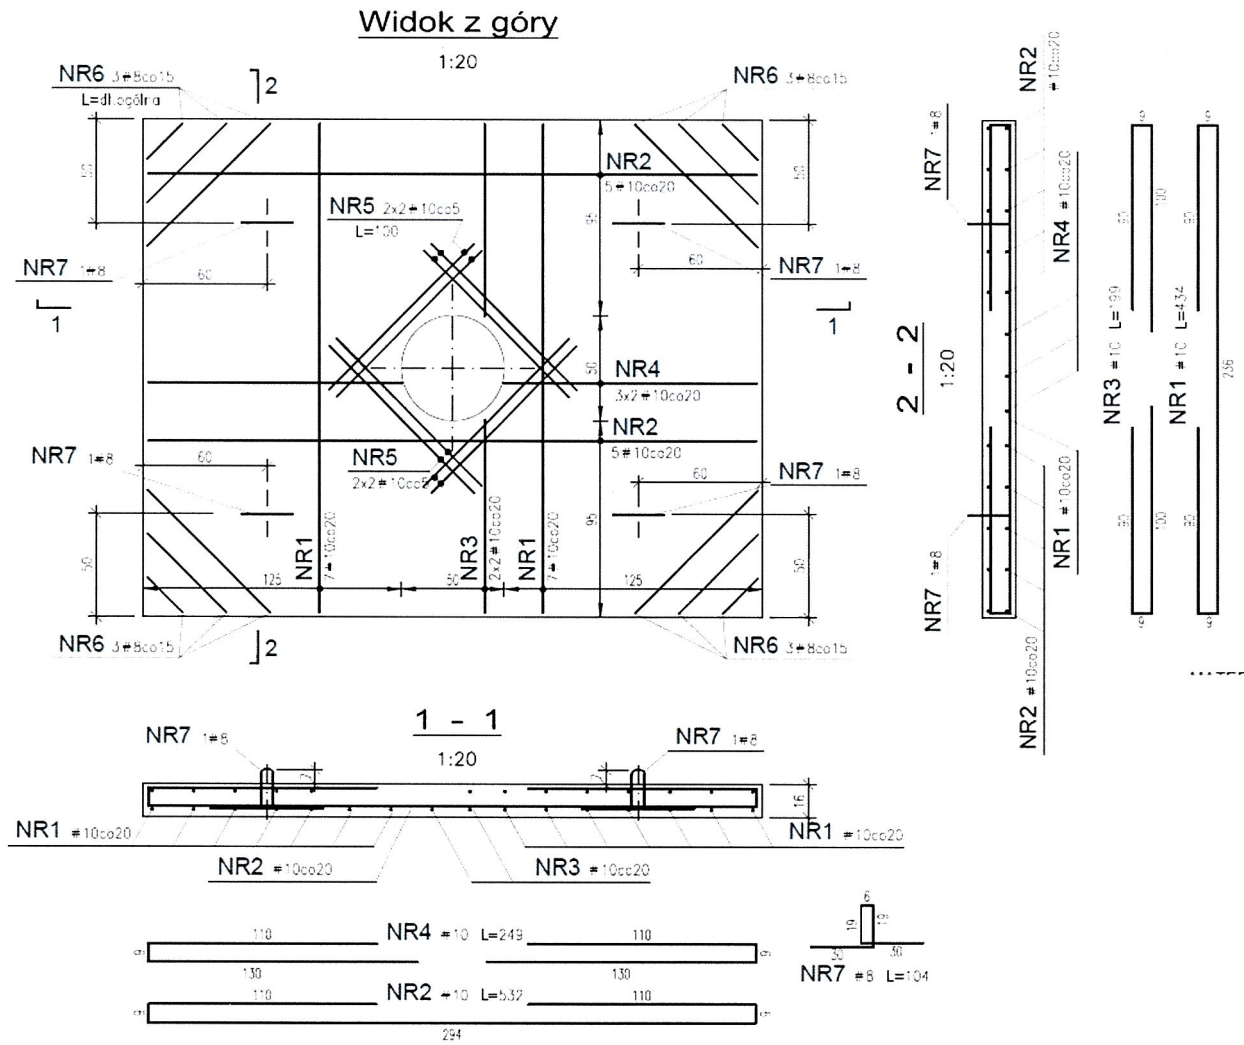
Zbiornik żelbetowy Eko+ 12W
